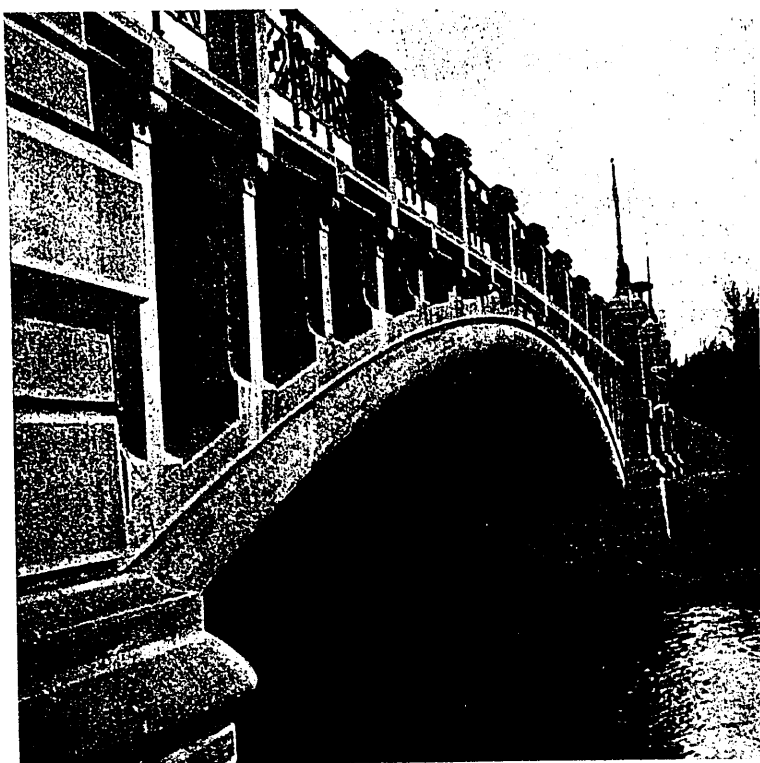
ª Puente Reina Victoria, con la colaboración del arquitecto D. Julio M. Zapata
